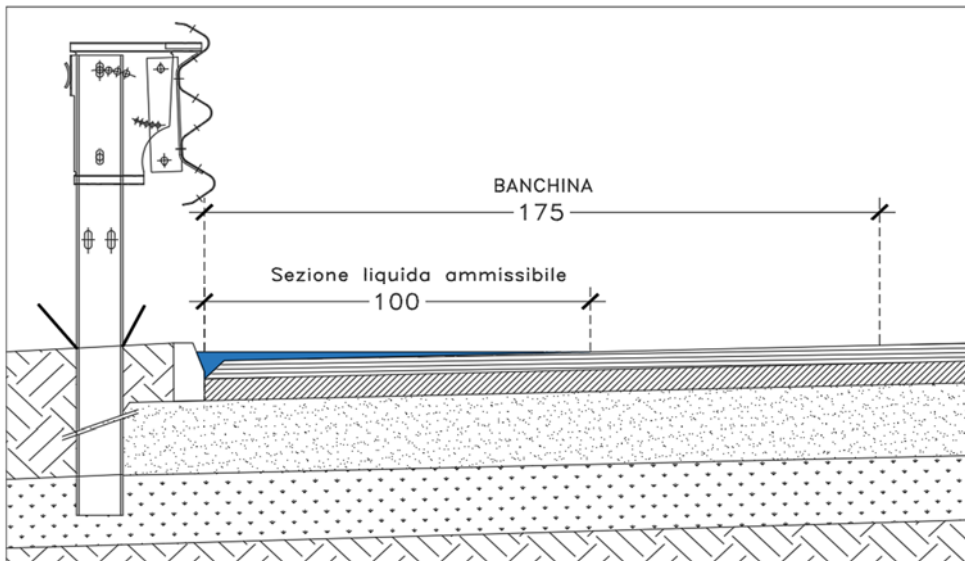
Sezione liquida in rilevato e viadotto
